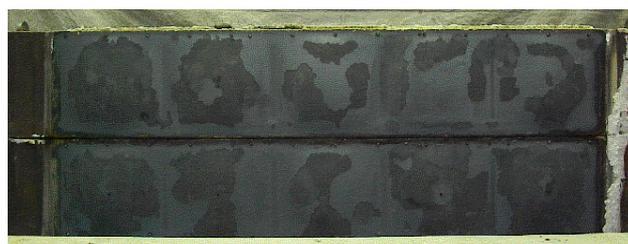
無被覆コンクリート充填鋼殻試験体(CFSS2)加熱面状況
